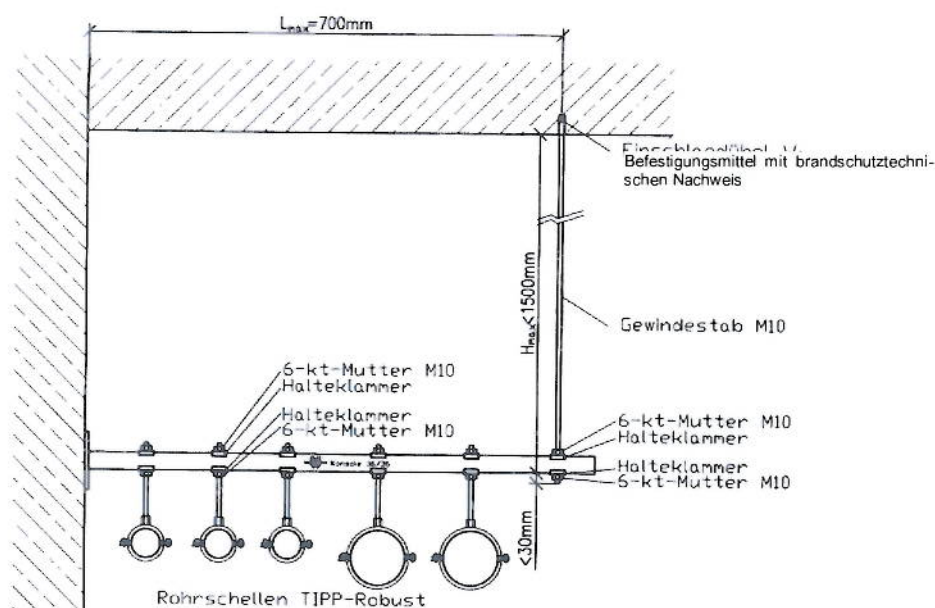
Schematische Darstellung von Konsolensystemen, befestigt mit Gewindestangen und Muttern, Schrauben oder Dübeln der Dimension $\geq M10$ (Festigkeitsklasse ≥ 4.6) mit brand-schutztechnischem Nachweis in Verbindung mit Würth Halteklammern, mit unterseitig montierten Installationen
